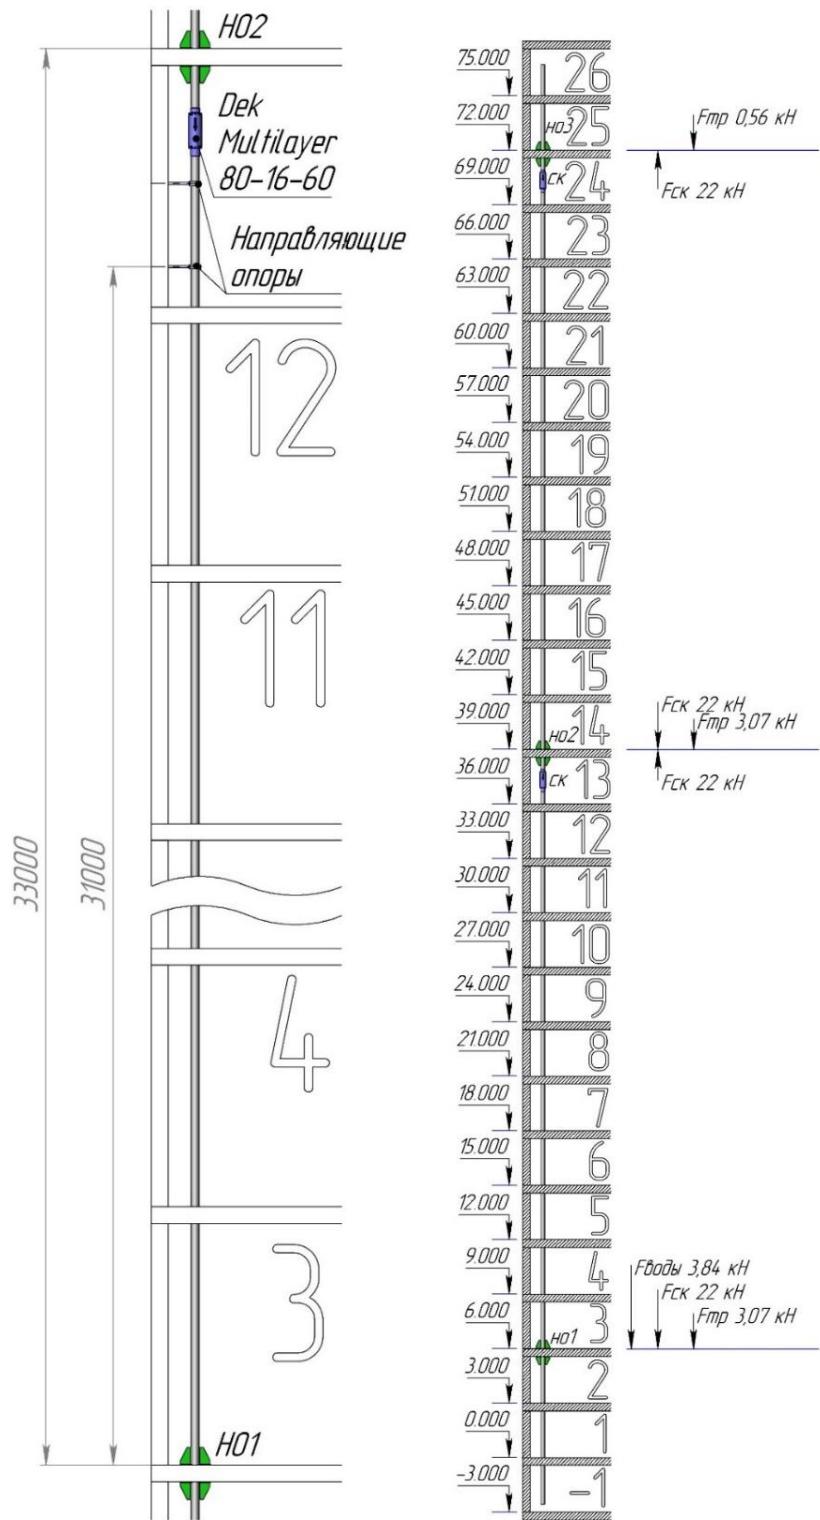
Распределение нагрузок на неподвижные опоры трубопровода ХС Ду80
